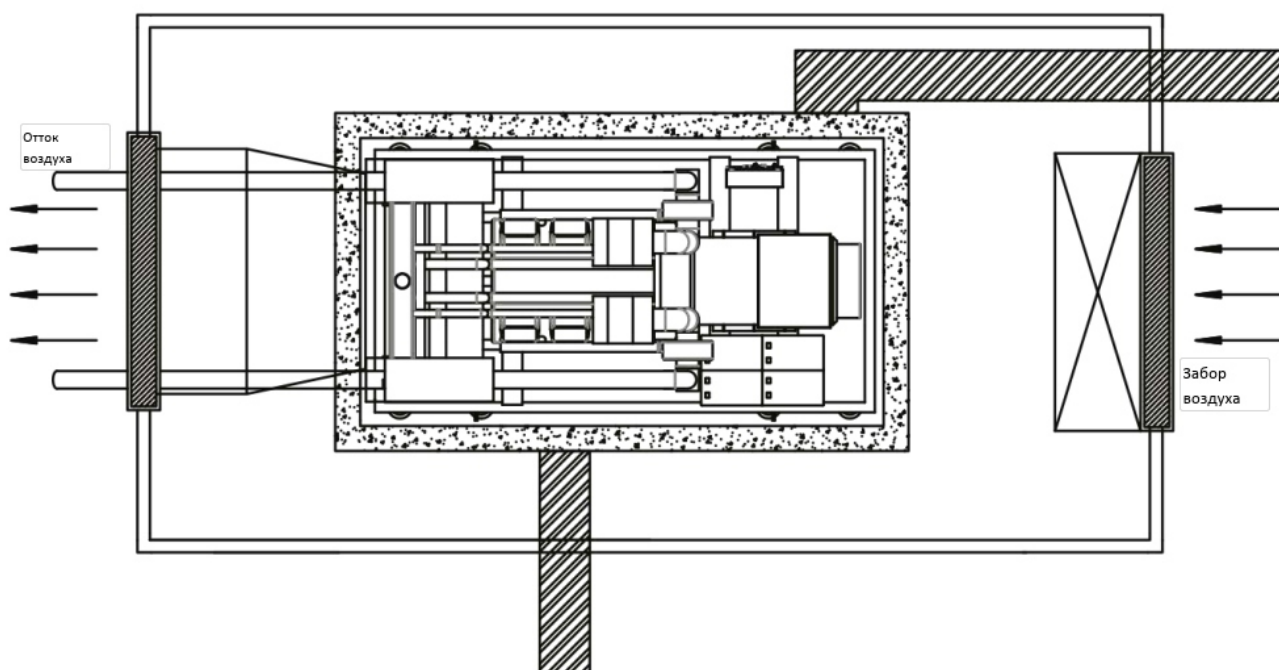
Схема вентиляции генераторной установки без кожуха (вид сверху)
